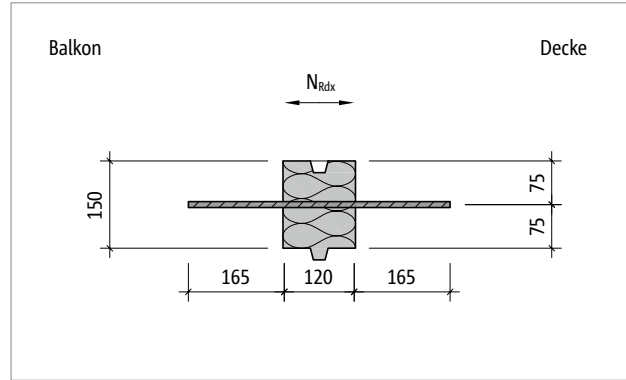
Schöck Isokorb® XT Typ HP-NN1: Produktgrundriss
